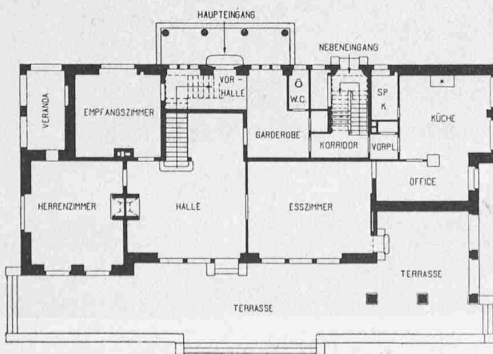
und 4. Grundrisse des Hauses Rammersbühl. — 1 : 400.
